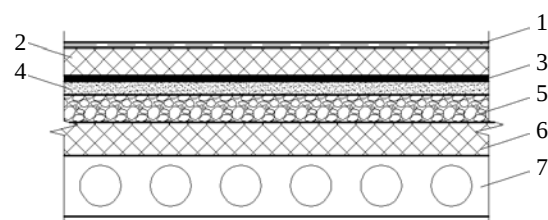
Рекомендуемое конструктивное решение кровли для выполнения реабилитации: 1 – водоизоляционный ковер из ПВХ-мембраны; 2 – теплоизоляционный слой из сверхжестких минераловатных плит (по расчету); 3 – рулонный водоизоляционный ковер (существующий); 4 – цементно-песчаная стяжка (существующая); 5 – слой керамзитового гравия по уклону (существующий); 6 – слой теплоизоляции (существующий); 7 – железобетонная многопустотная плита покрытия (существующая)
